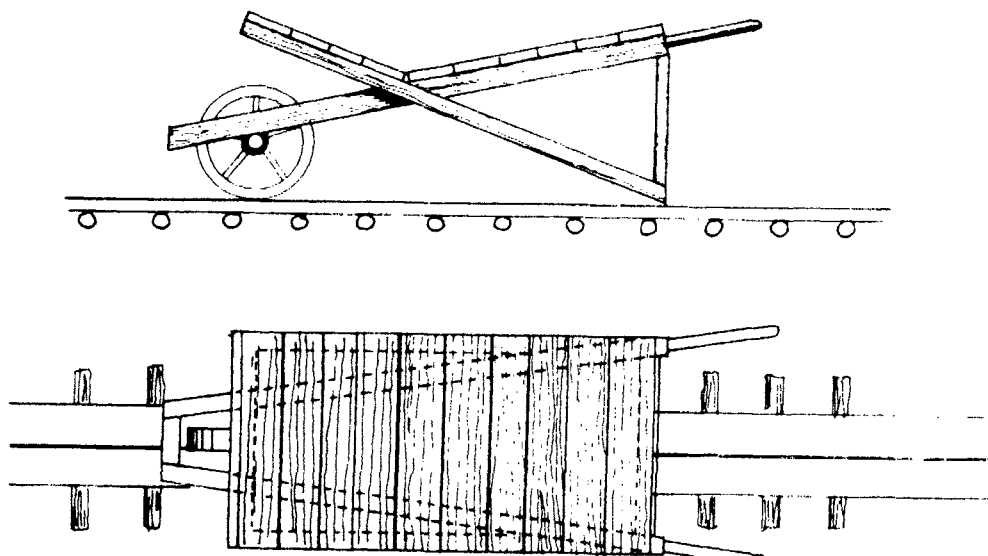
Utilisation de la brouette sur un chemin étroit de planches
